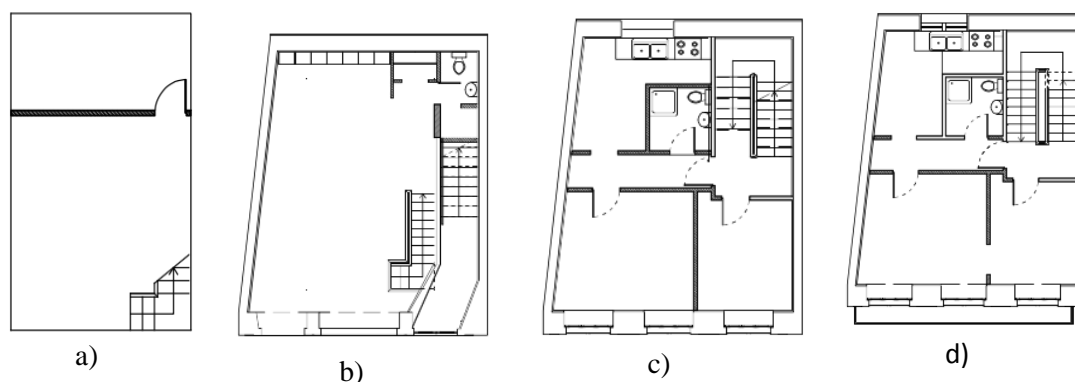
Plantas CAD do caso de estudo antes da intervenção: a) planta da cave; b) planta do R/C; c) planta do primeiro andar; d) Planta do segundo andar.
